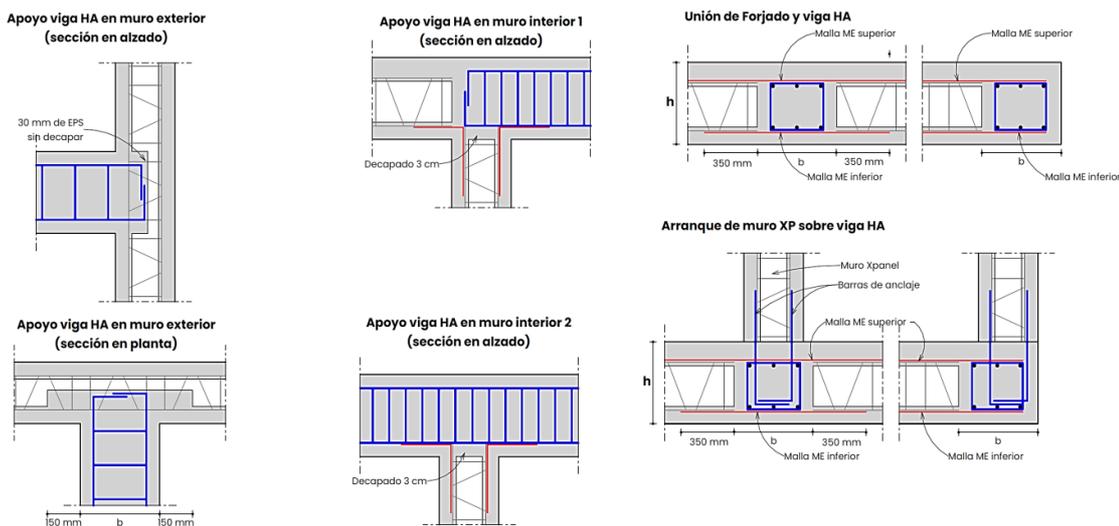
Detalle de unión entre muros interiores y forjados (en sección)
